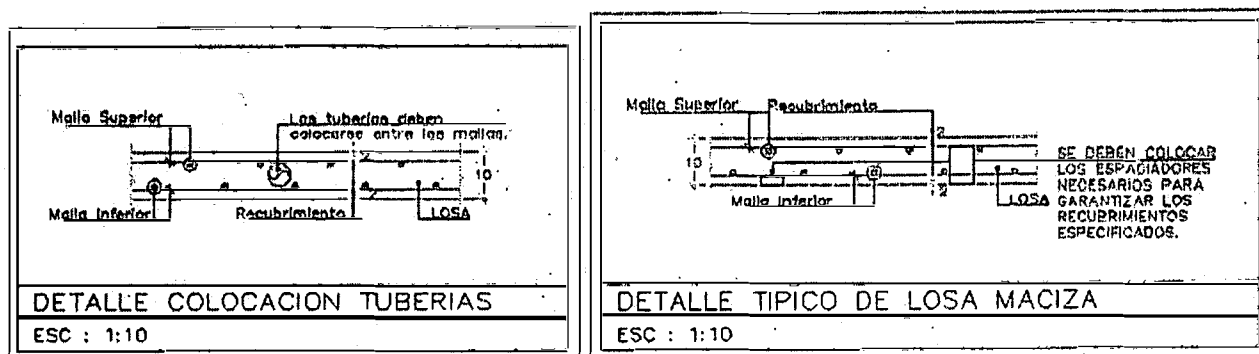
Detalle de tubería y refuerzo en placa tipo. (Tomado del plano estructural n.º05. V.1. Planta de vigas piso tipo. Marzo 2018)
